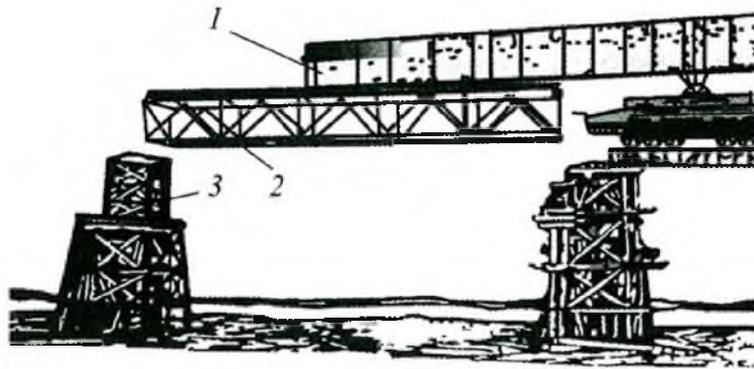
Установка пролетного строения на опоры консольным краном:
